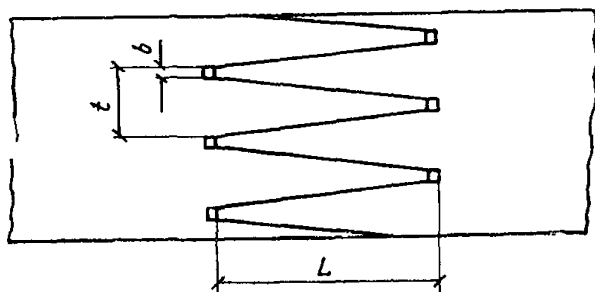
Размеры применяемых зубчатых клеевых соединений
